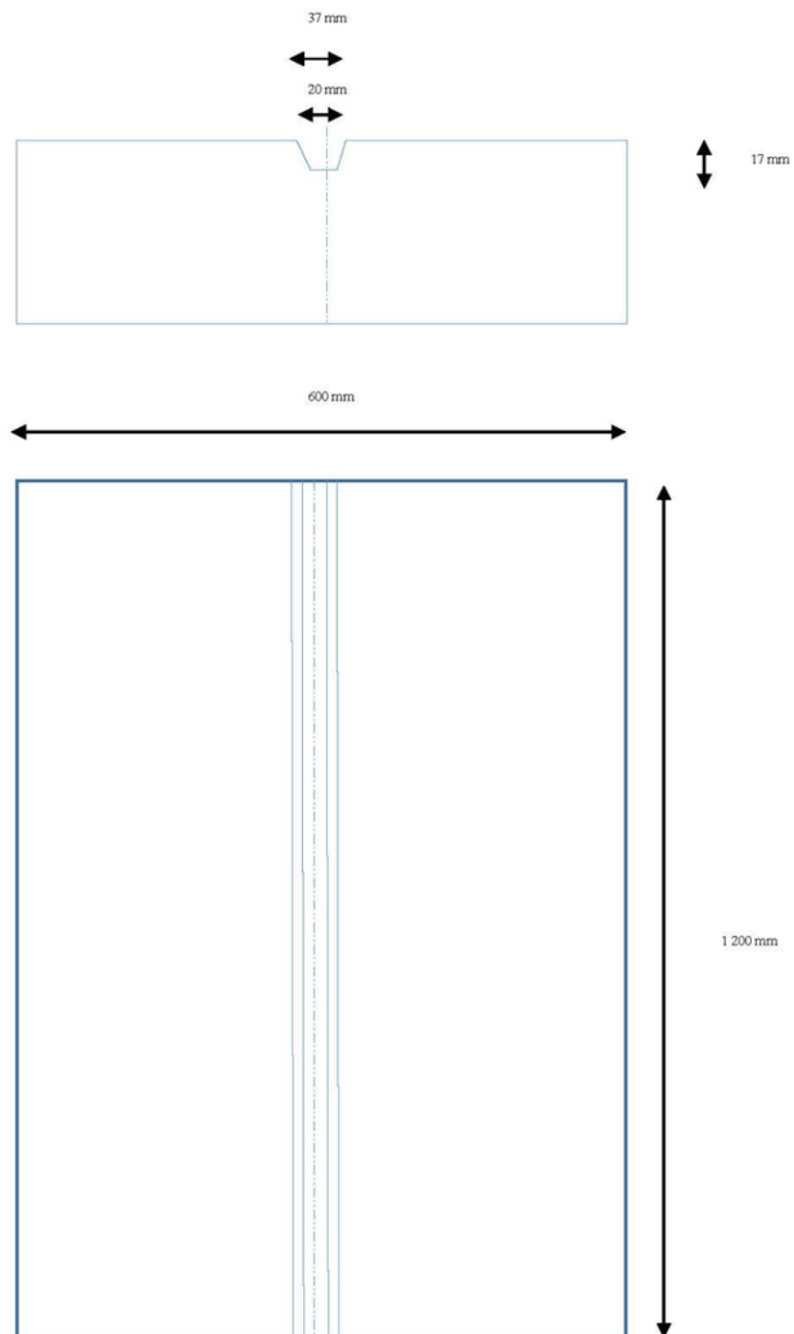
Panneaux à bossage en U 37 (dimensions en mm)
